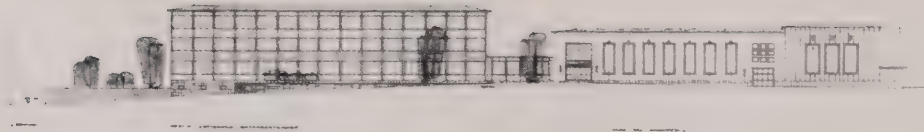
Die Fassadenabwicklung Rathausstraße
